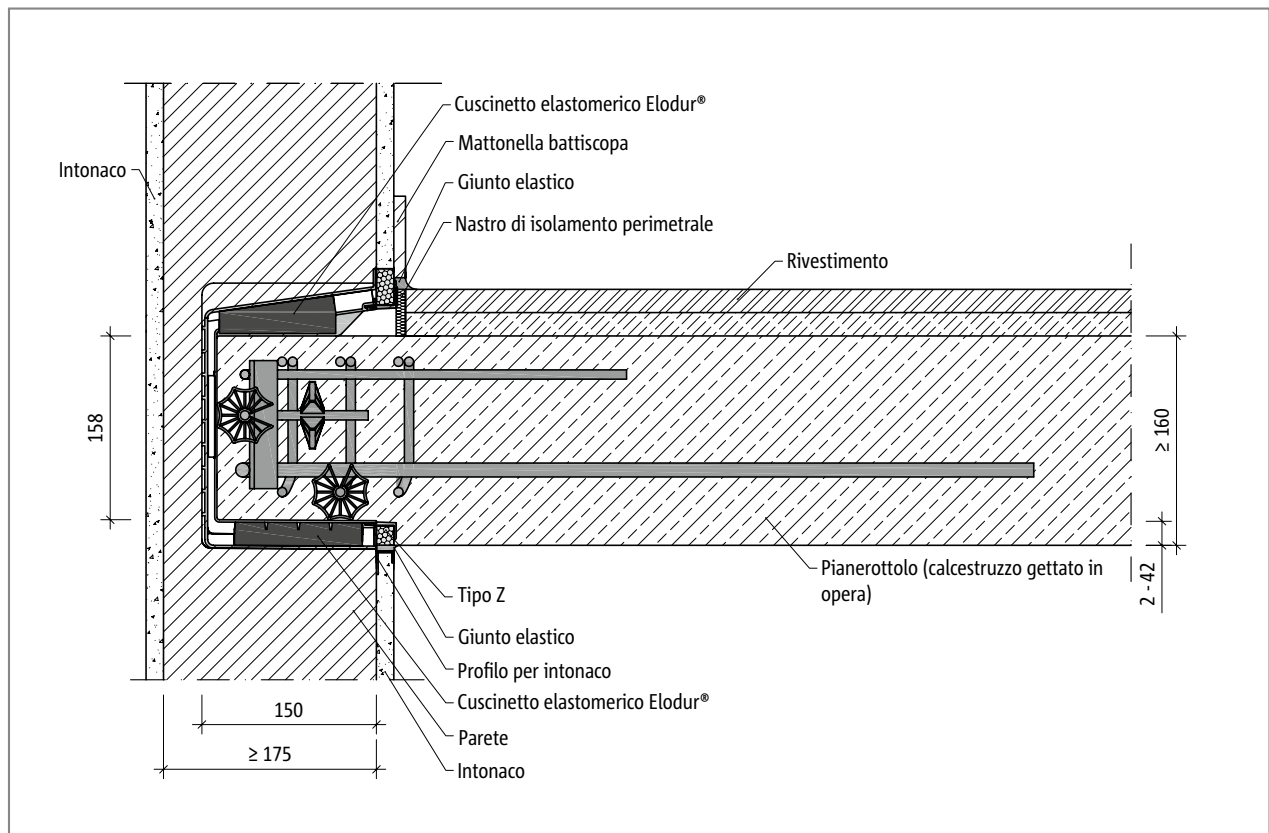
Schöck Tronsole® tipo Z-V+V-T: sezione costruttiva - Pianerottolo in opera
